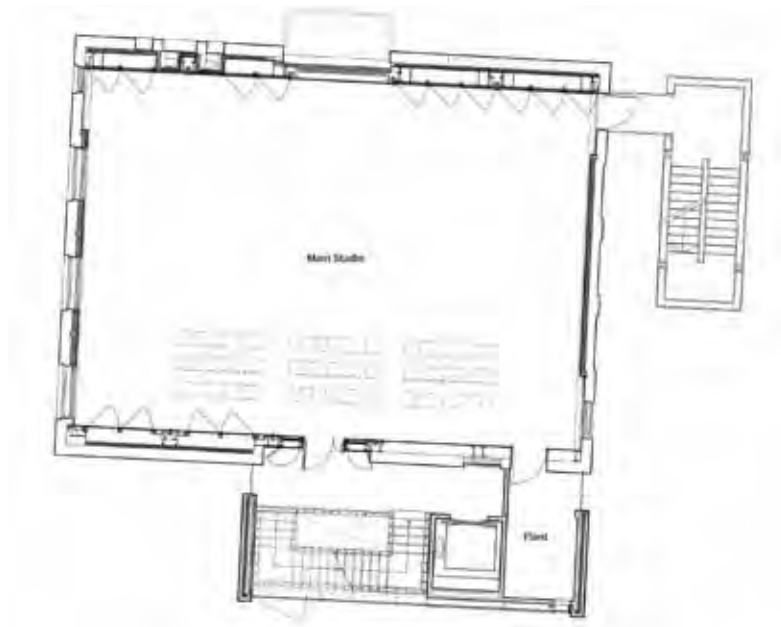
Grundriss © SarahWigglesworth Architects
